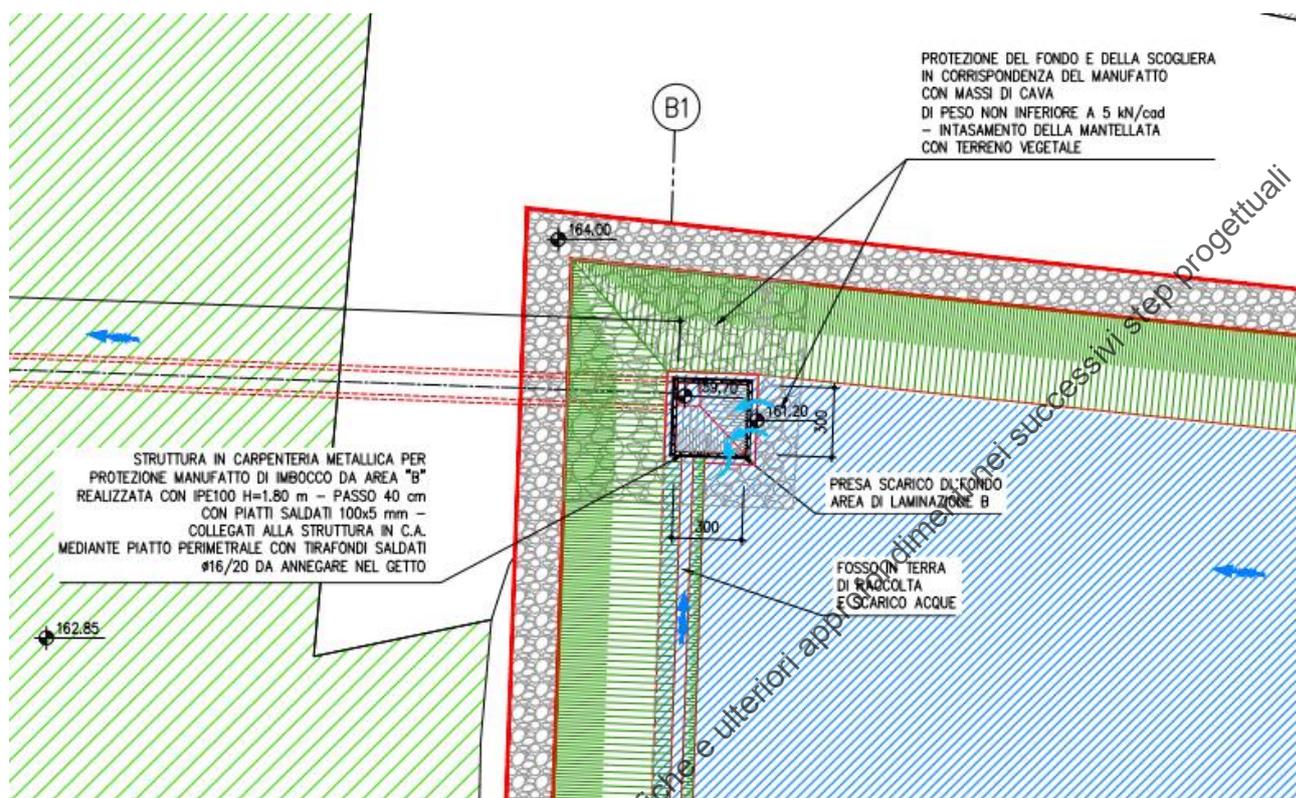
presa dello scarico dell'area di laminazione B. Estratto da Tav. 13.2
